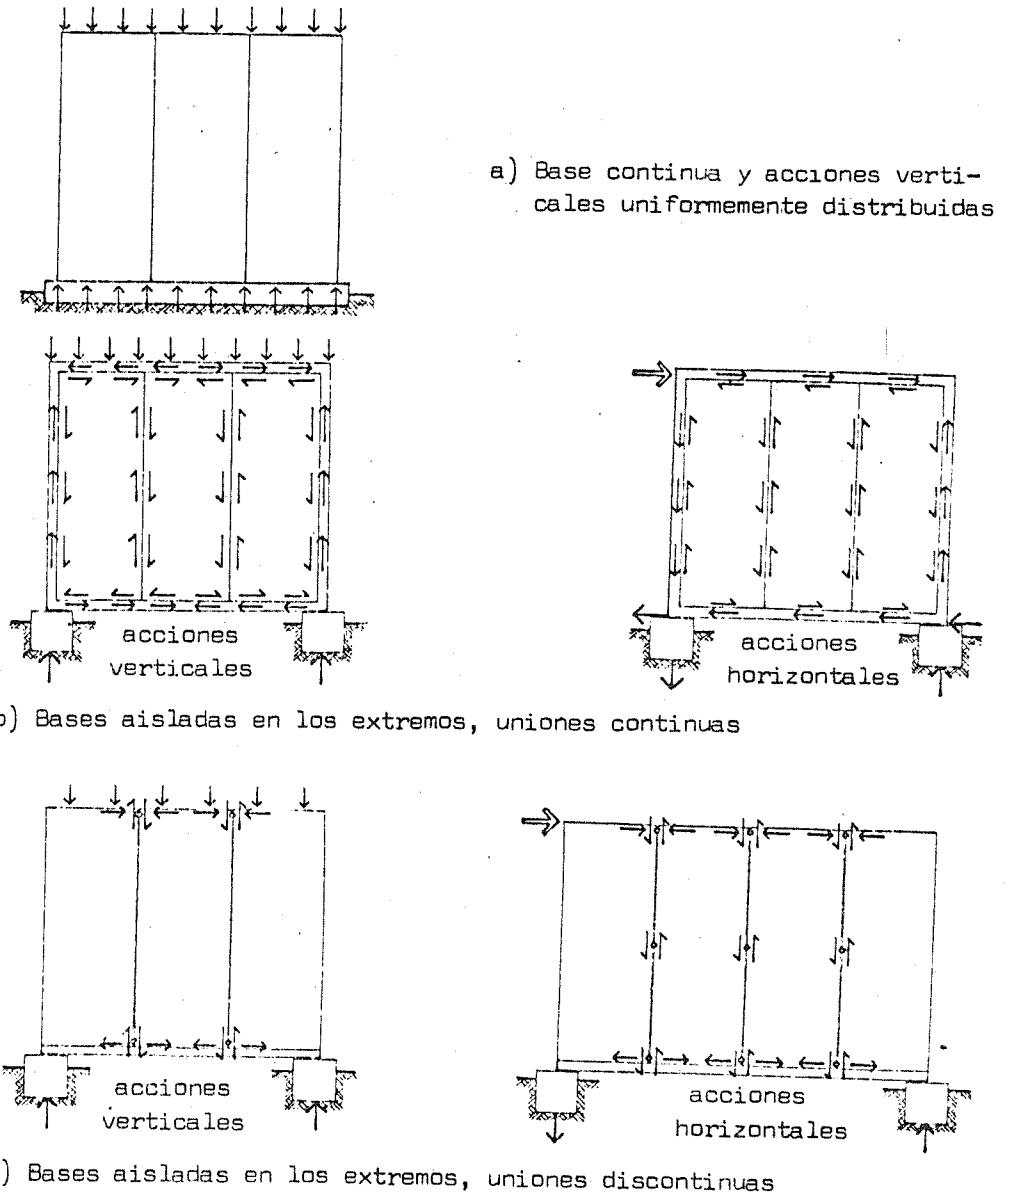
Solicitaciones en las juntas entre paneles prefabricados
